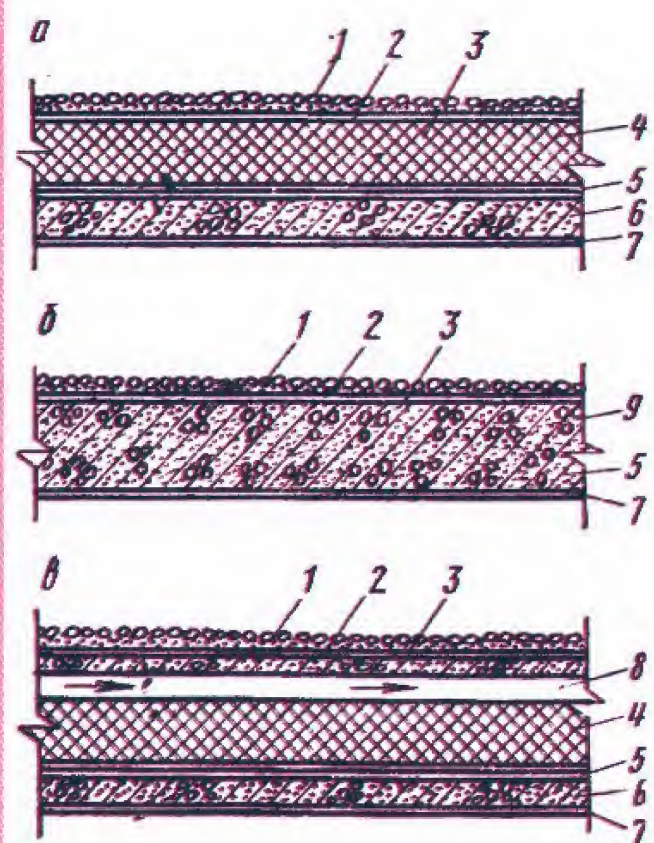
Принципова схема дахів, що мають спільну конструкцію з перекриттям: а - дах, що не має вентиляції, з теплоізоляцією; б - те ж саме, але сумісно з несучою конструкцією; в - дах, що має вентиляцію; 1 - верхній шар; 2 - рулонний килим; 3 - стяжка; 4 - теплоізоляція; 5 - пароізоляція; 6 - несуча конструкція; 7 - оздоблювальний шар; 8 - повітряний прошарок; 9 - теплоізоляційний несучий шар.
